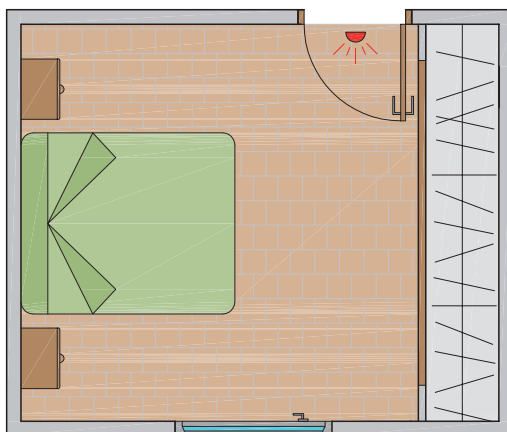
Vista en planta de dormitorio accesible de matrimonio.
